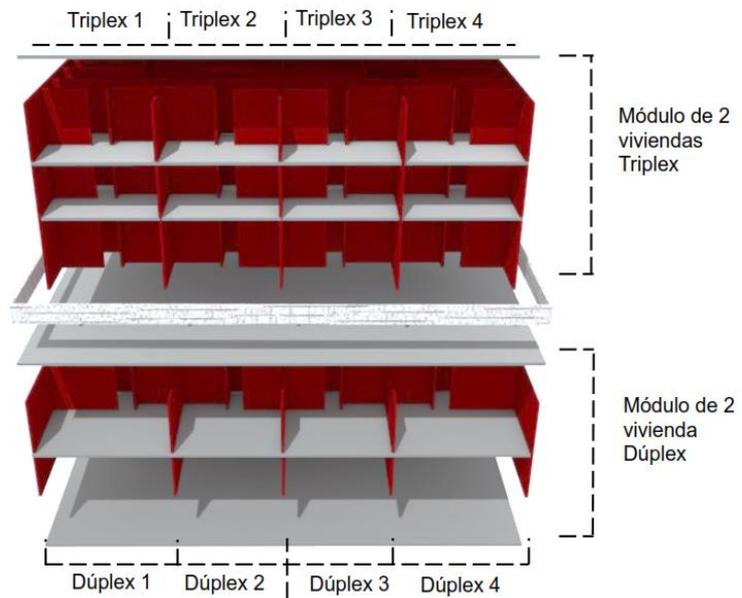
Proporción estructural en el Conjunto Hbitacional la Muralla
